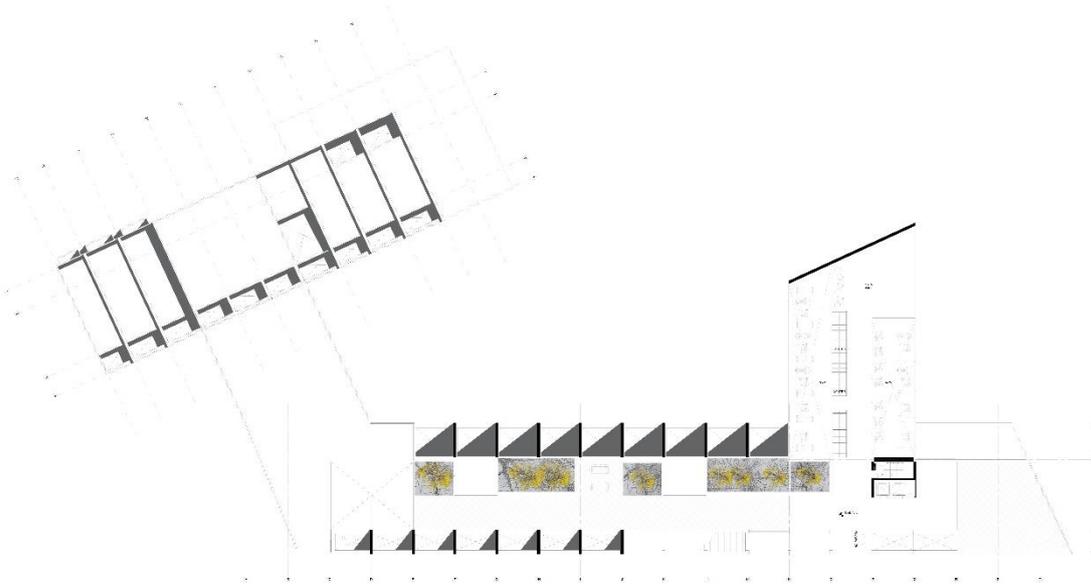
Planta cubierta. remate de la barra e ingreso a la torre. Nivel + 10.80.
